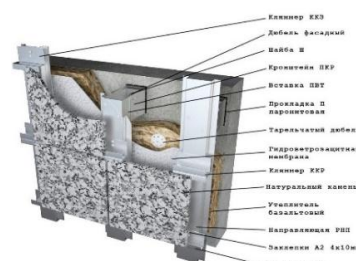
Конструкция стены навесного фасада с каменной плиткой.
